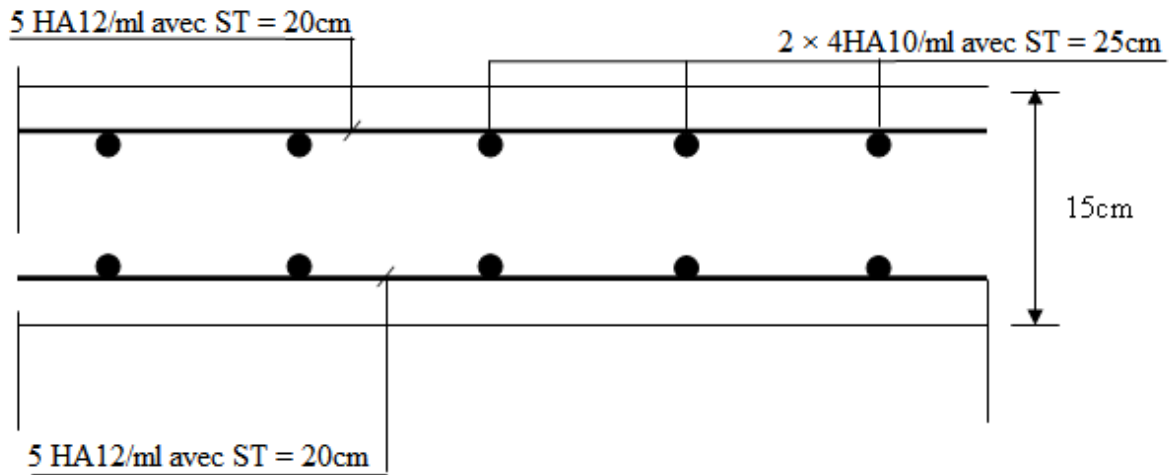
Ferrailage de la dalle dans le sens y-y.
